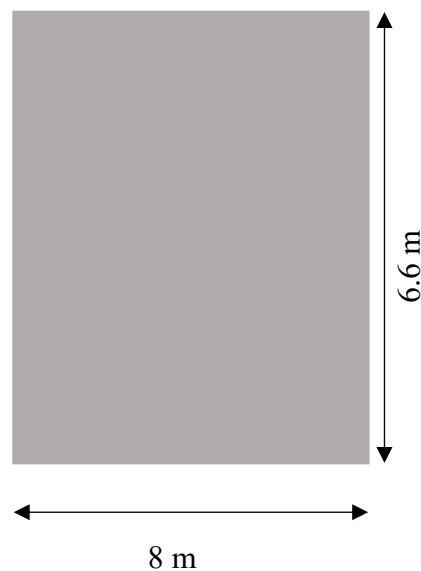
Dimensions de dalle pleine rectangulaire (Panneau 9 ).
